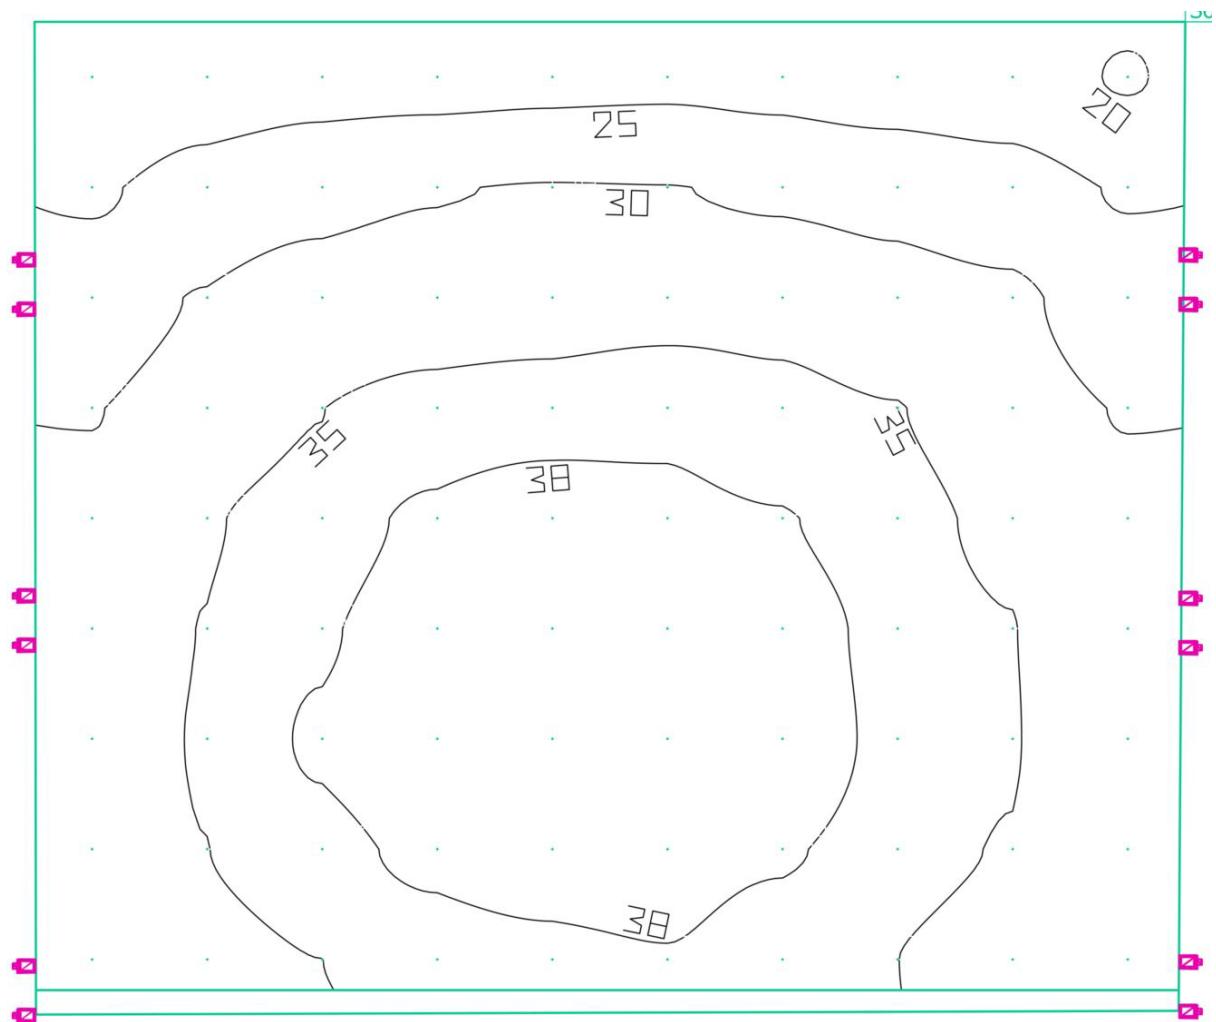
Plano isolux propuesta cine-patio de butacas iluminación proyectores.
